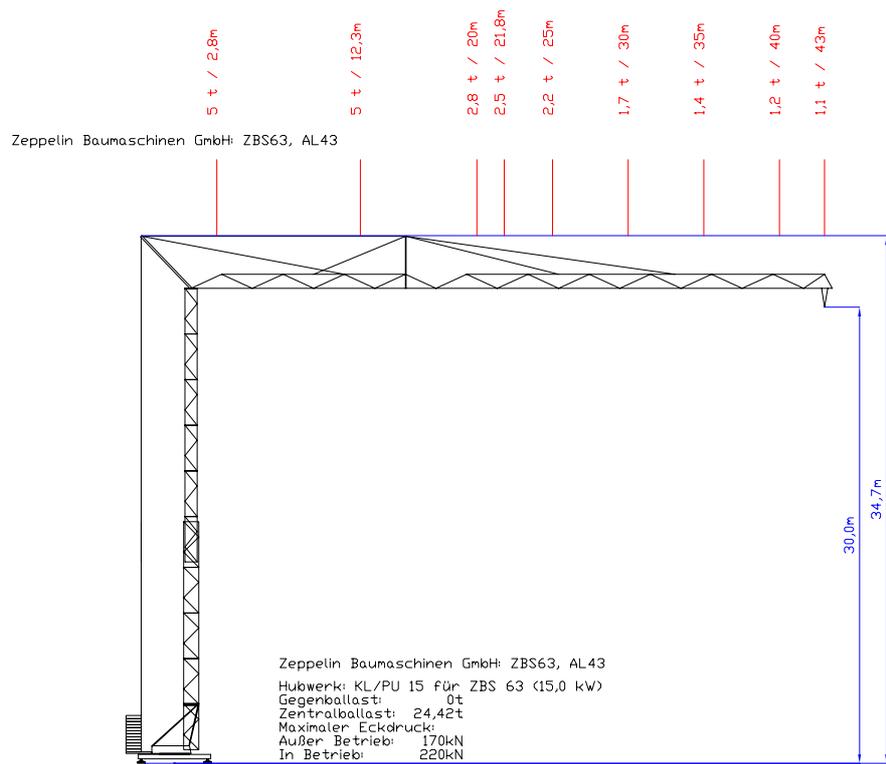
Unten drehender Katzausleger in der Seitenansicht
